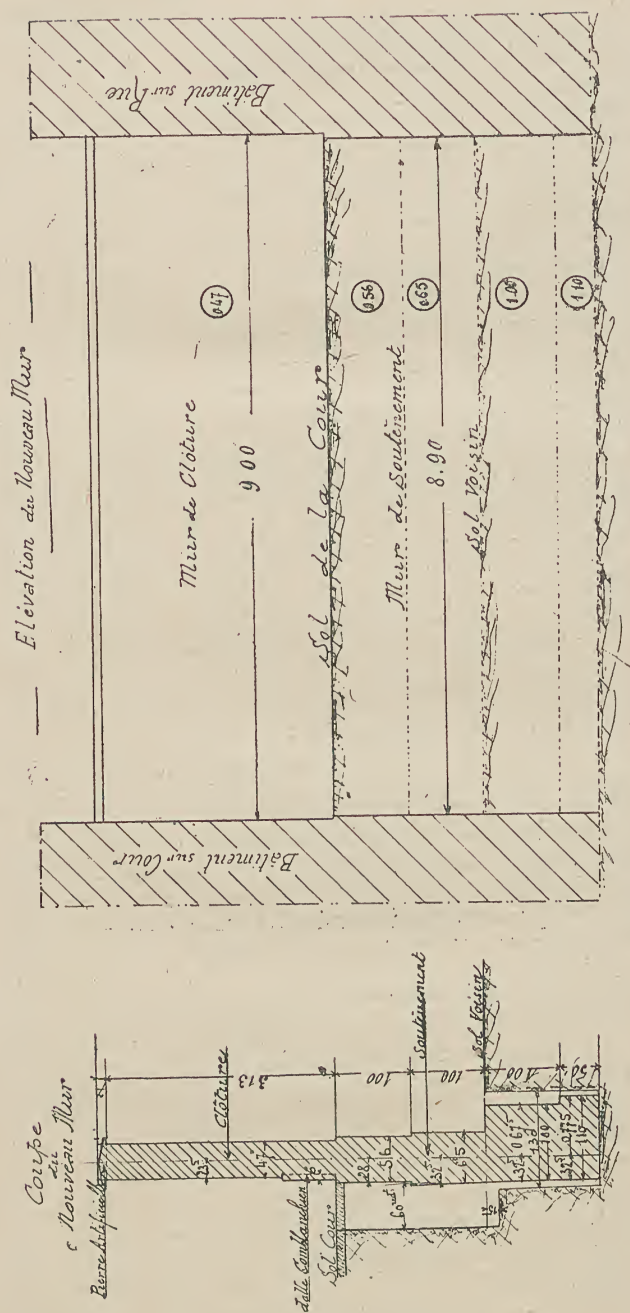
Coupe et élévation du nouveau mur de clôture.
